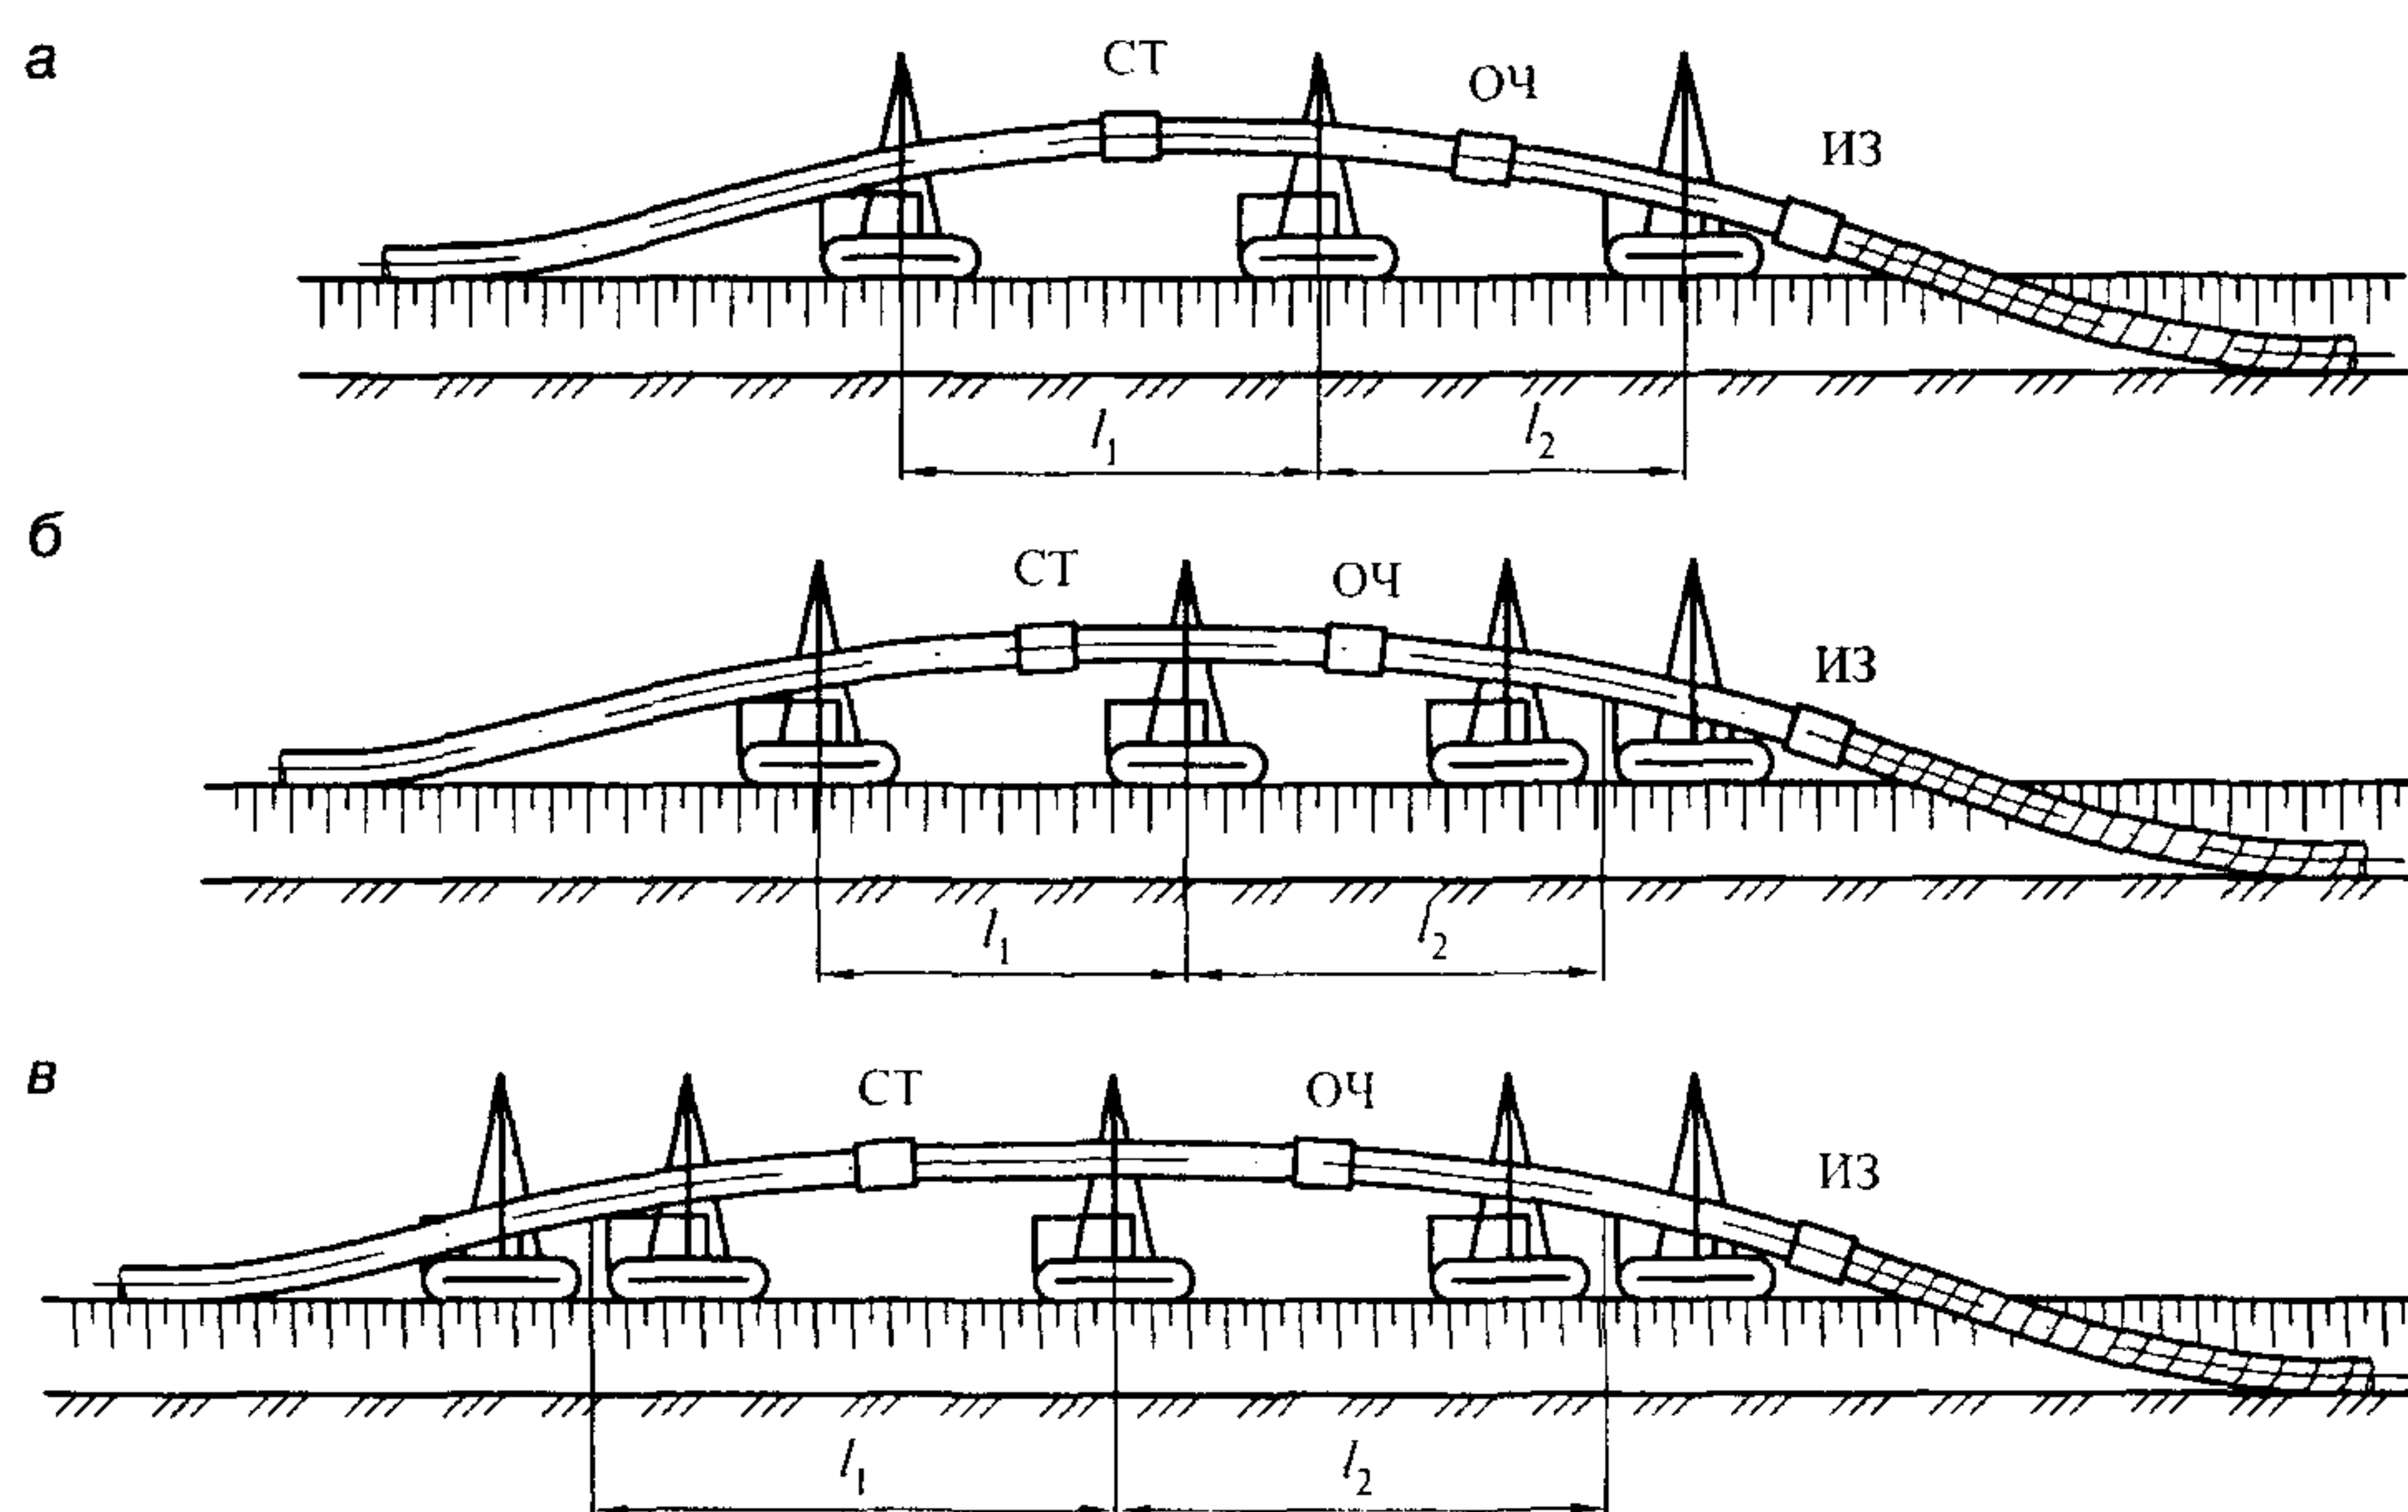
Совмещенный способ изоляции и укладки газопровода диаметром: а, б, в — то же, что и на рис. 21
